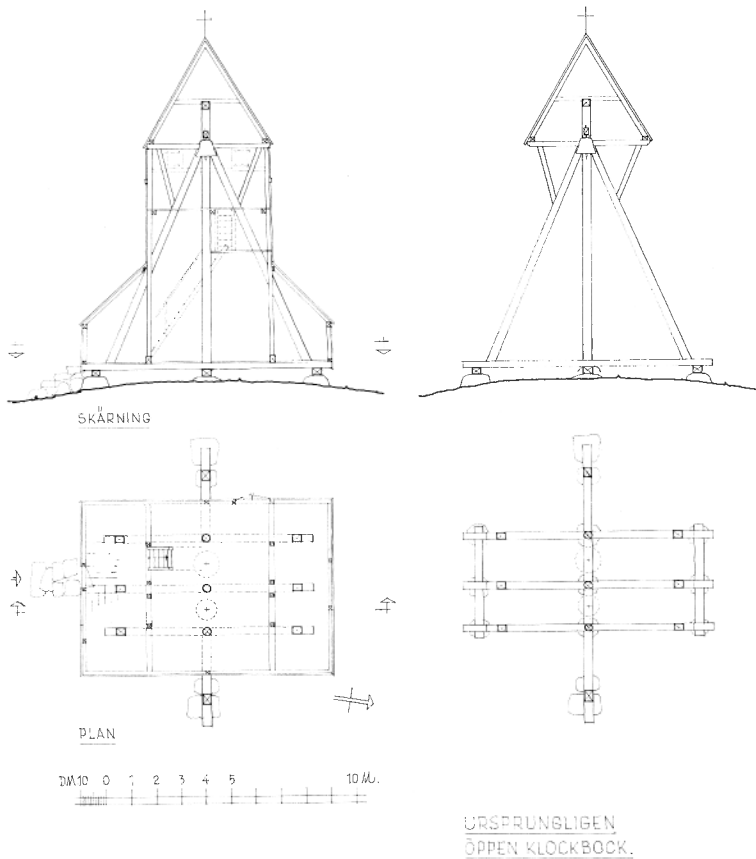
Klockstapel, sektion och plan, samt rekonstruktion av ursprungligen öppen klockbock. Uppm J Söderberg 1967.
